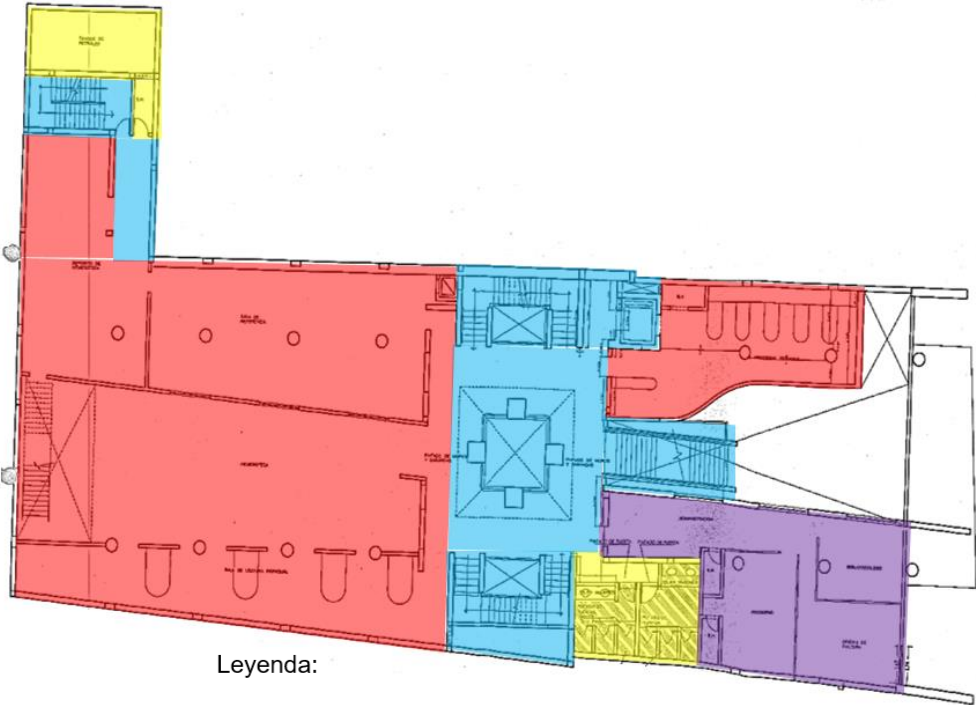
Primera Planta del Centro Cultural Ricardo Palma
